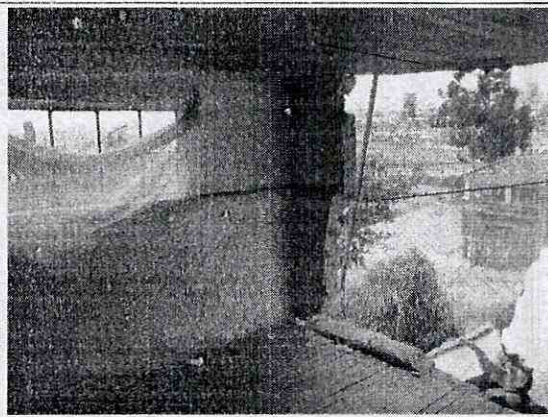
Detalle de la zona del costado norte de la vivienda, donde se presenta el colapso del muro de cerramiento.
